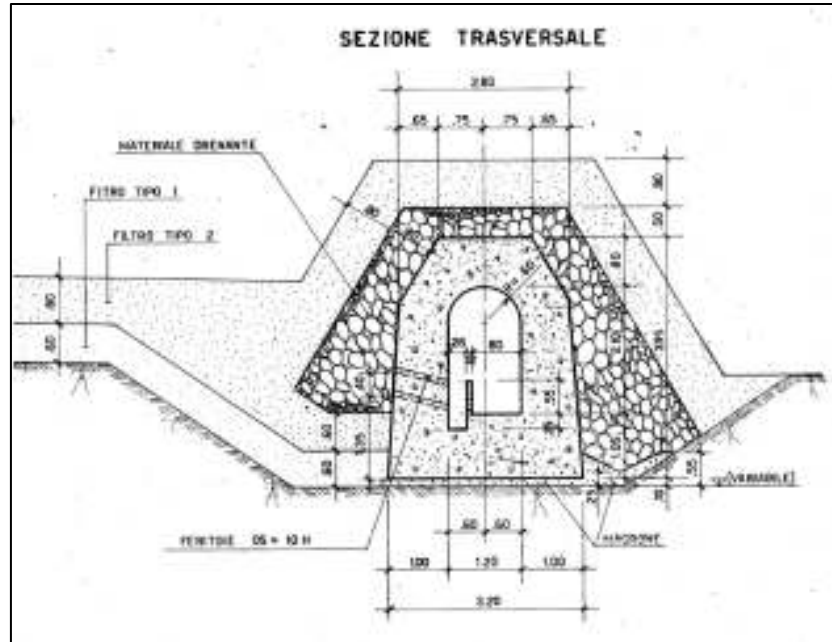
Cunicoli di ispezione delle acque di drenaggio – Sezione tipo
